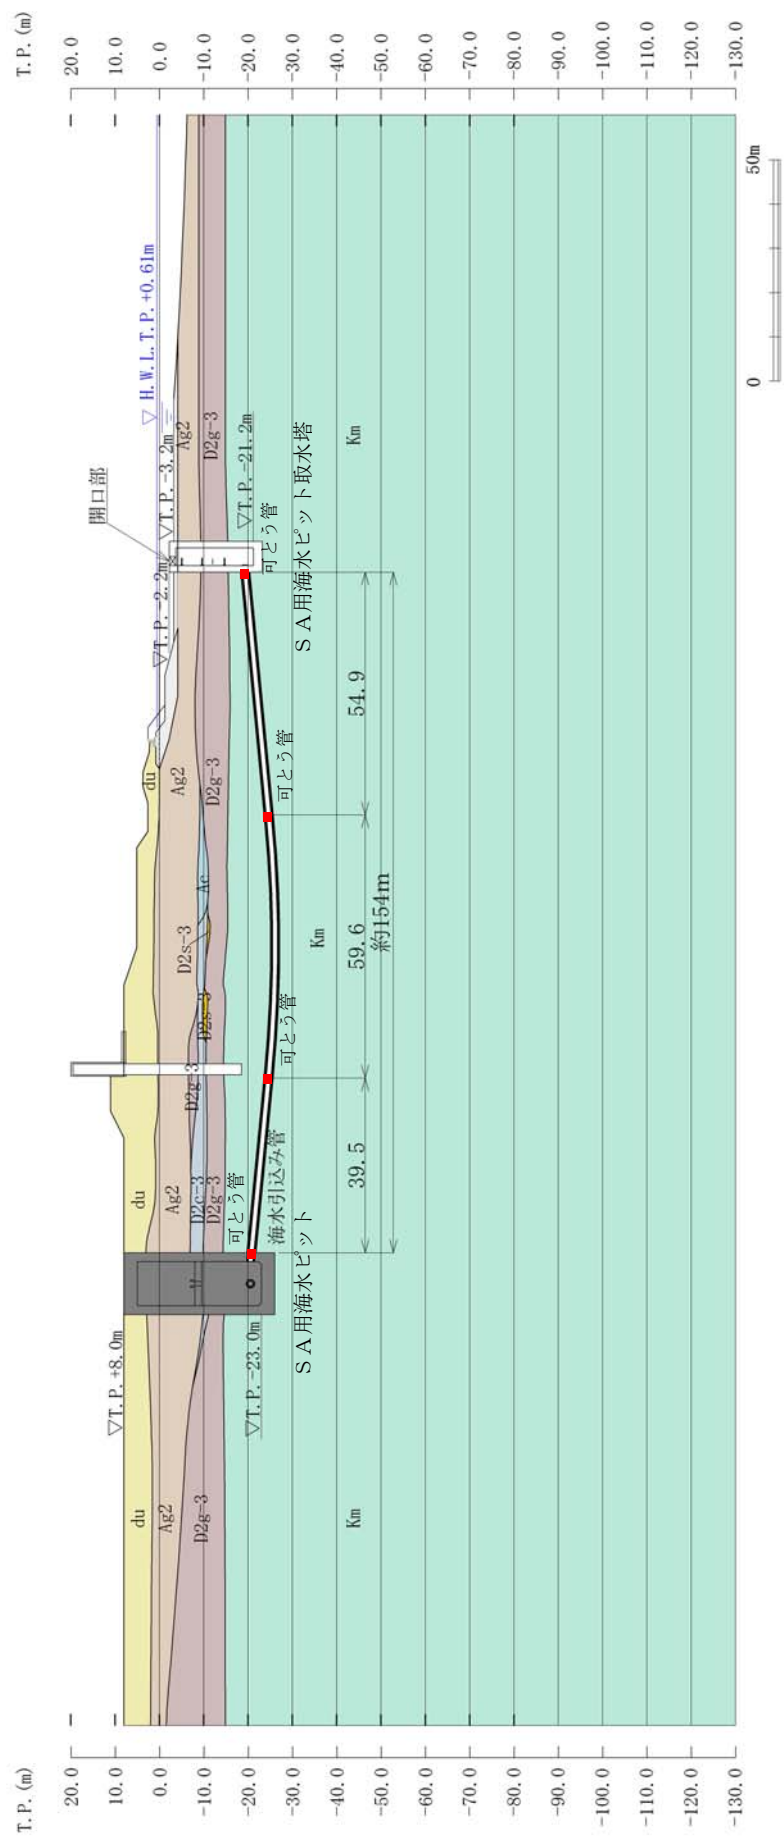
(1) SA用海水ビット 評価対象断面図 (①-①断面)
